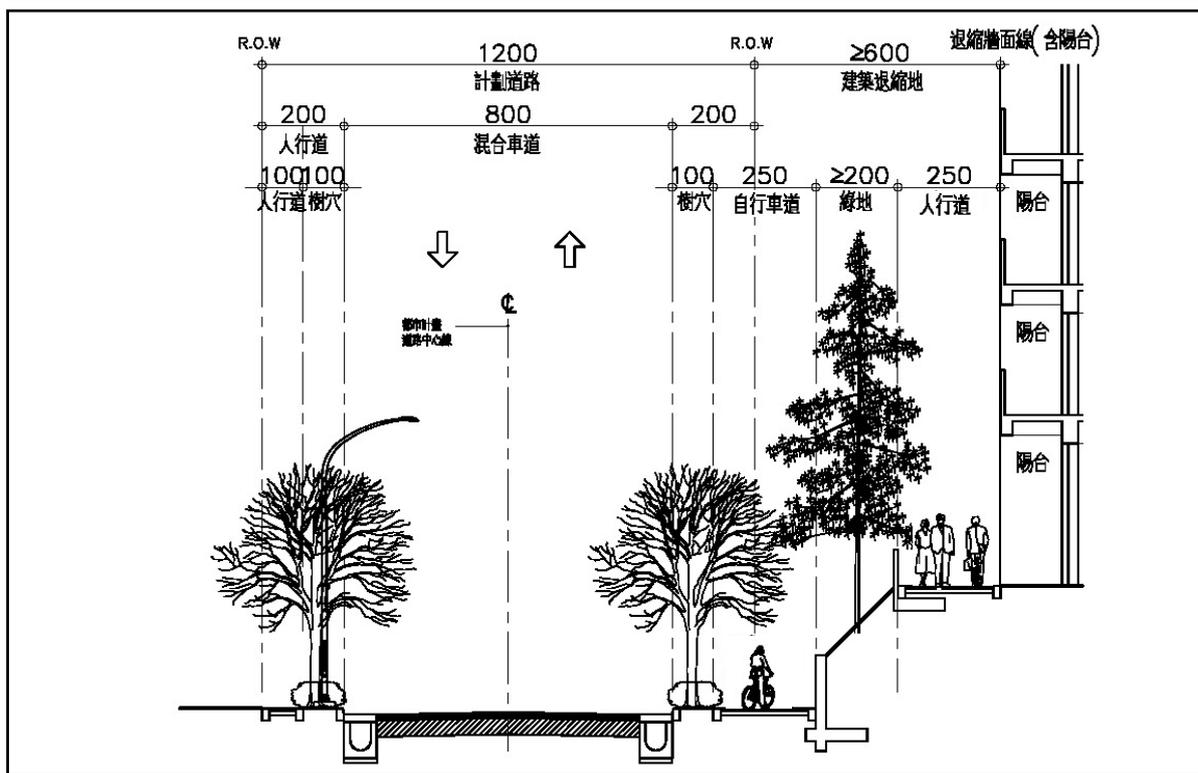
建築基地臨道路退縮空間配置示意圖（二）
